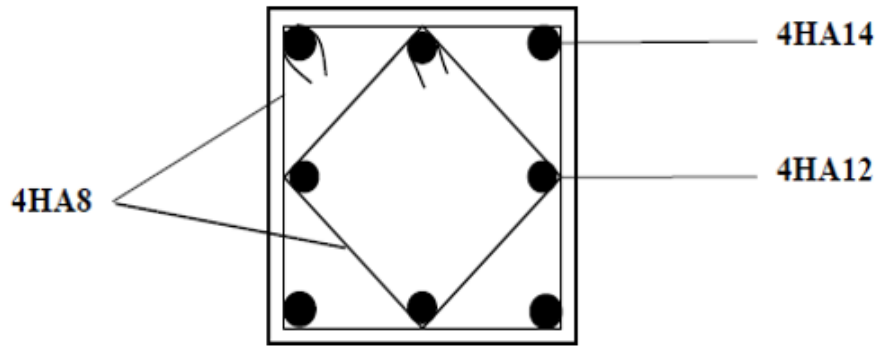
Schéma de ferrailage des poteaux 7.8.9ème étages
